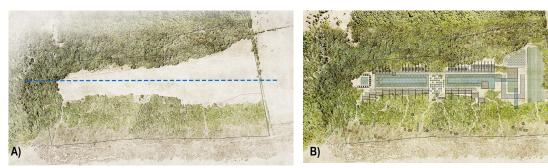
Distribución esquemática de conjunto. A) Sin proyecto y B) Con proyecto (Imagen de Dron con planta general sobrepuesta).
